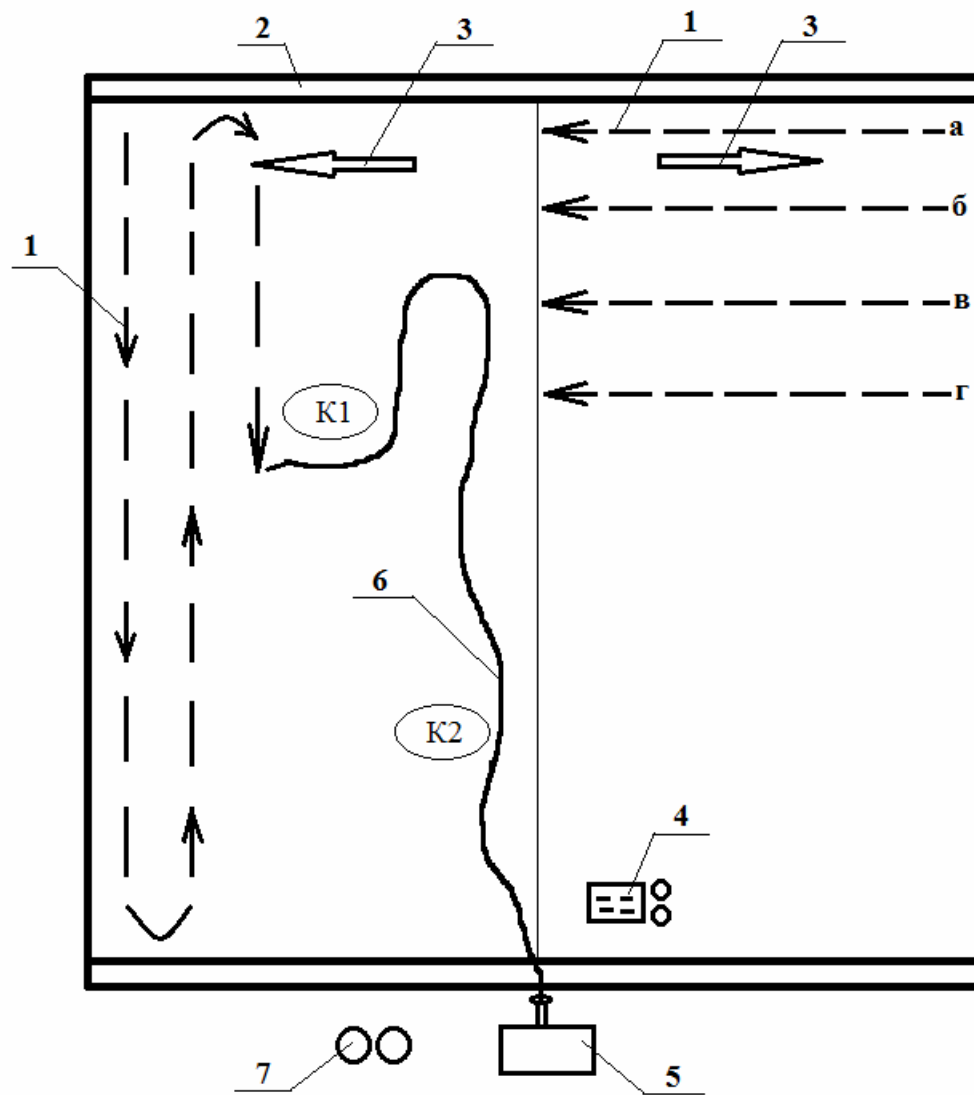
Схема организации рабочего места при устройстве кровли из мастики "Профикс", размещение насосной станции возле здания:
